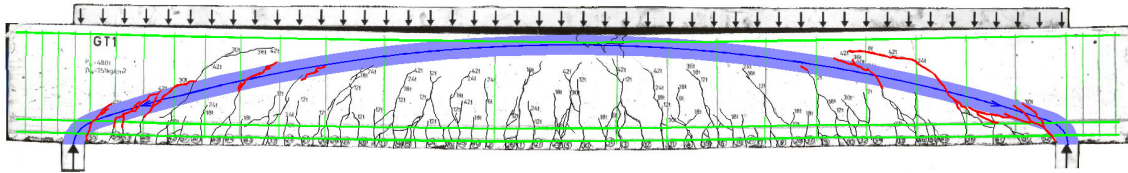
Balken GT 1 mit überlagerter Druckparabel und zugehörigen Rissen
